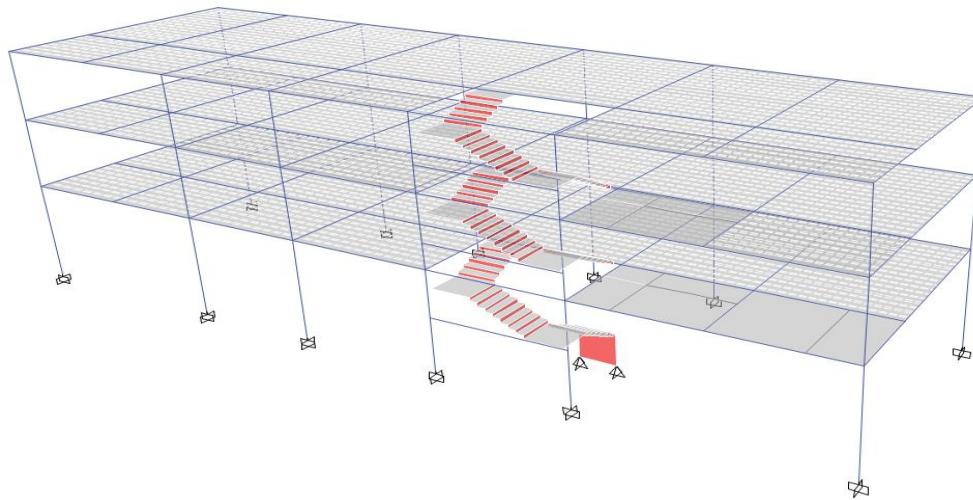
Análisis de la superestructura del Sistema estructural Tradicional – Vista 3 D.
